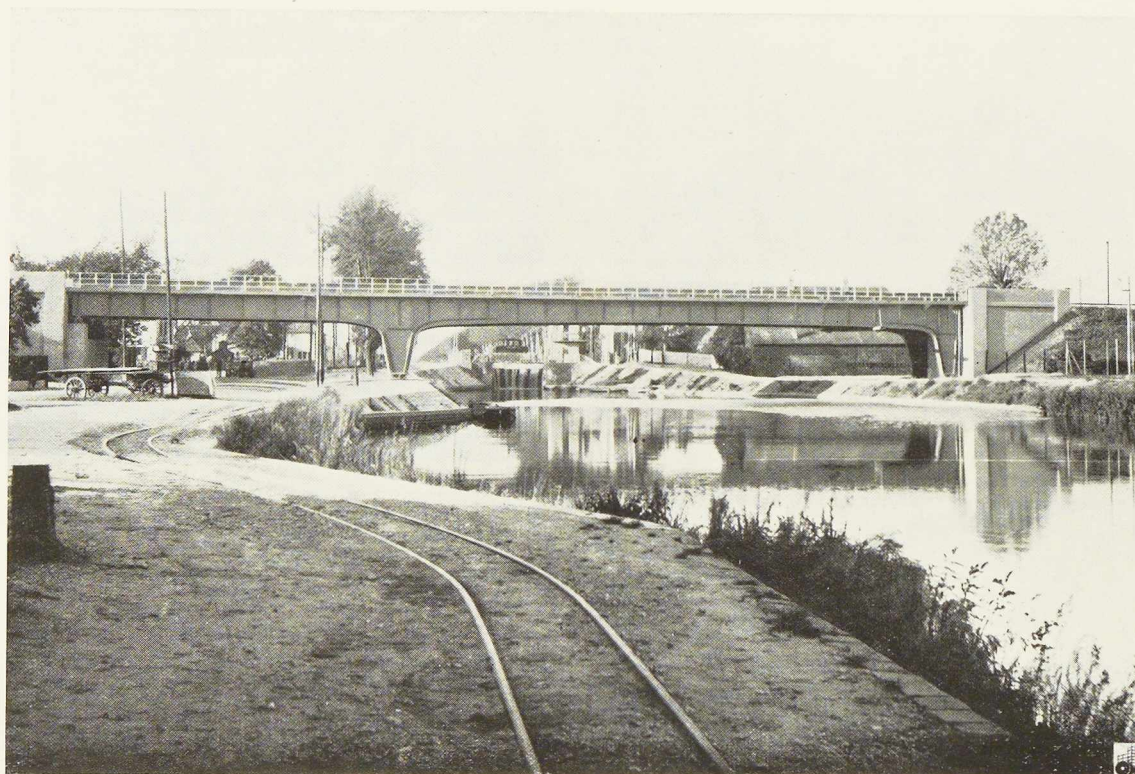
Vue générale du pont-rails à béquilles de 45^m20 de portée construit près de Strasbourg.
